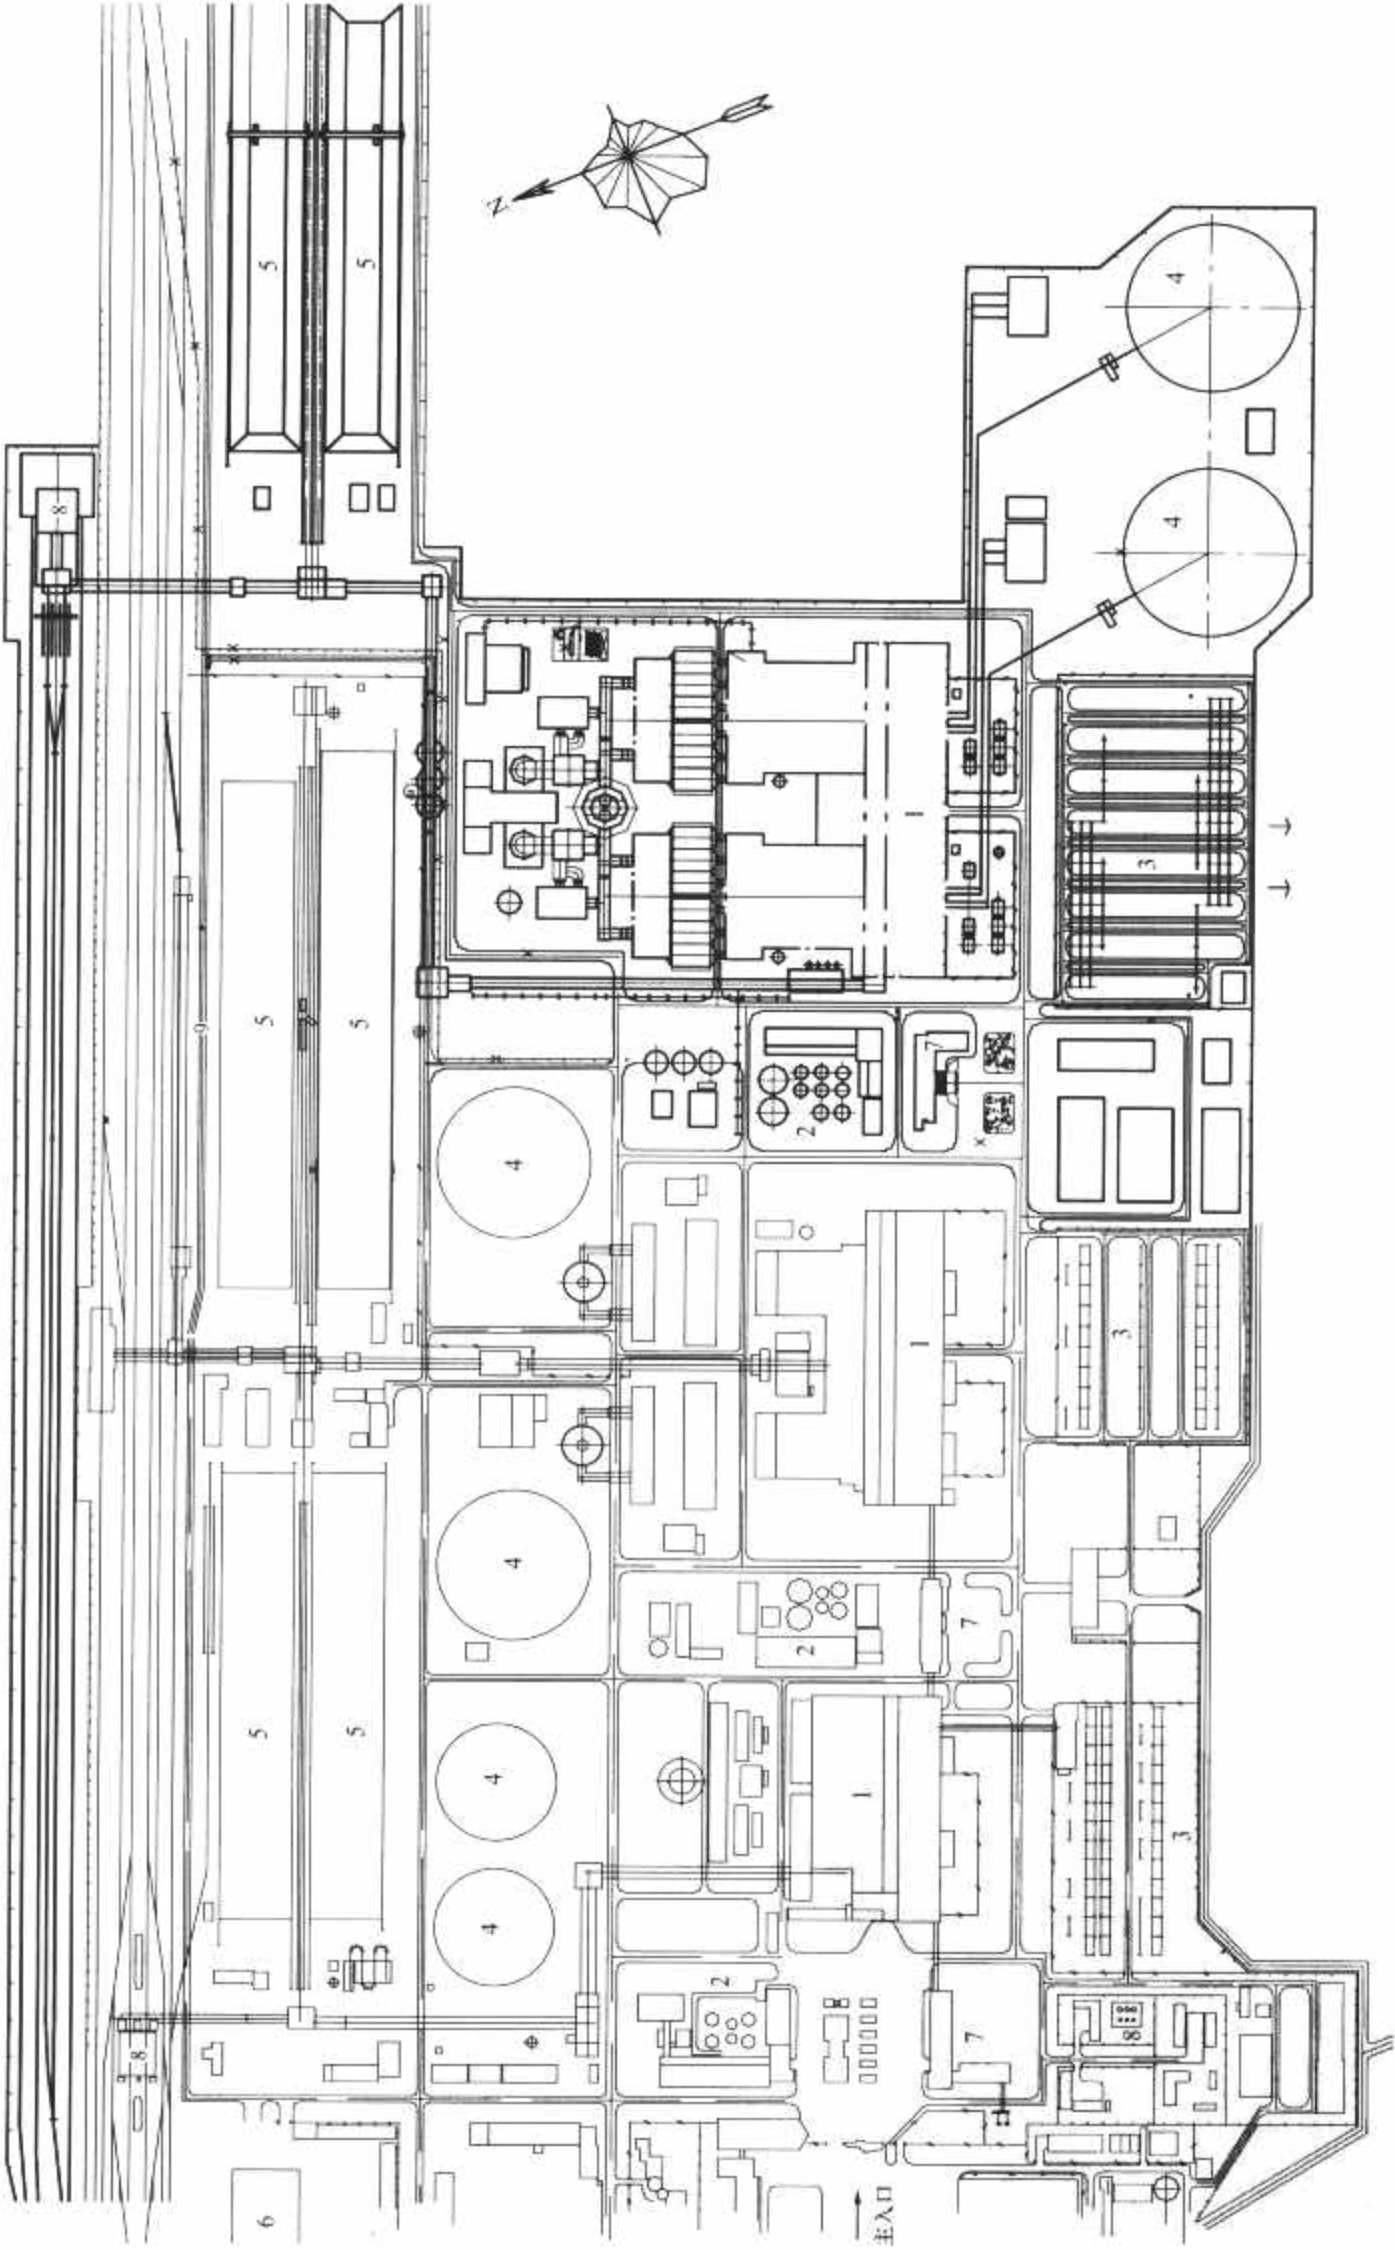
冷却塔布置在锅炉房外的四列式电厂总平面布置图
